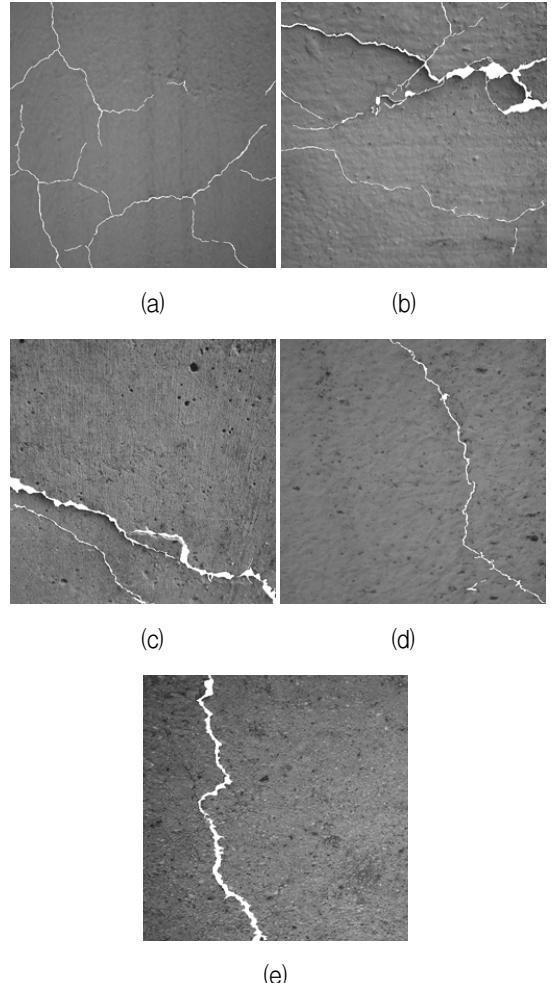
합성한 균열 영상들. (a) Crack1, (b) Crack2, (c) Crack3, (d) Crack4, (e) Crack5
